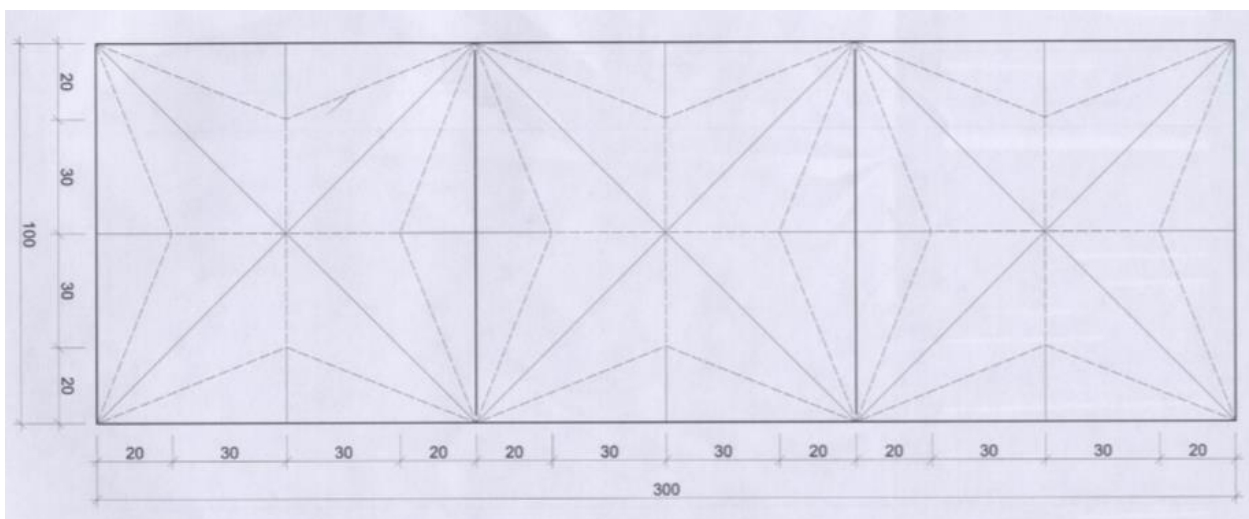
Схема изготовления складчато-прямолинейной структуры
